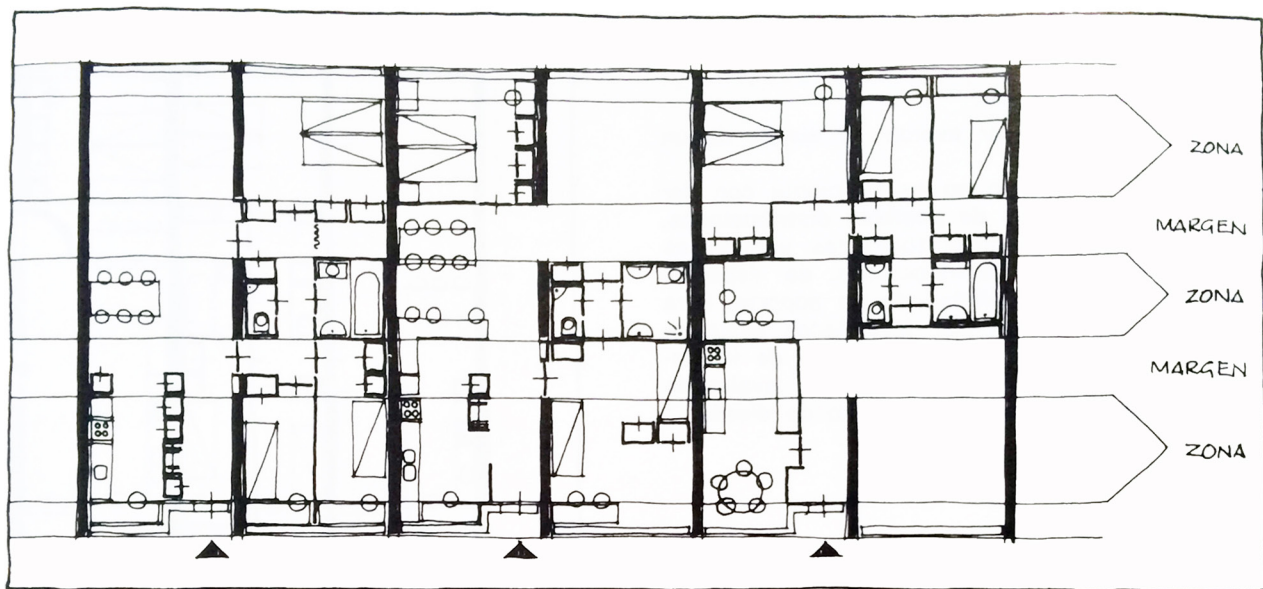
Desenho de suportes de N. John Habraken. A estratificação da planta em zonas e margens delinea a organização do espaço.
